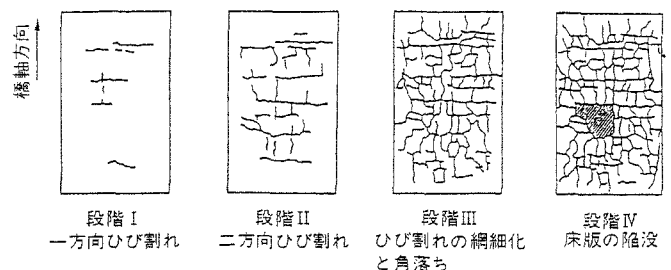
道路橋RC床版のひび割れ損傷過程<sup>3)</sup>
